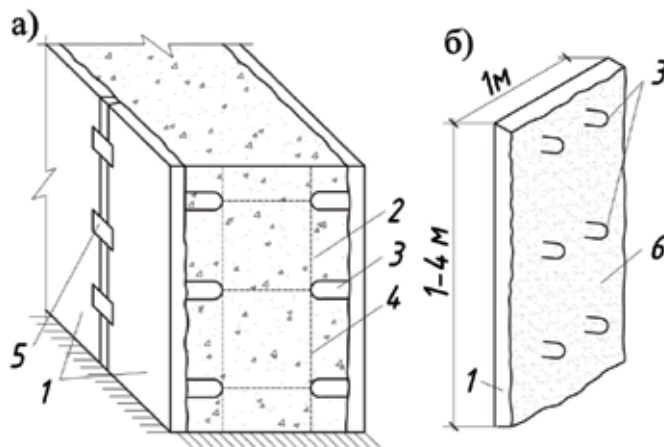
Конструкція тришарових стін: а – загальний вигляд; б – тонкостінні опалубні вироби; 1 – опалубні вироби; 2 – бетон основної конструкції; 3 – анкерні петлі; 4 – армокаркас; 5 – накладка для зварного з'єднання; 6 – активна поверхня опалубки.
